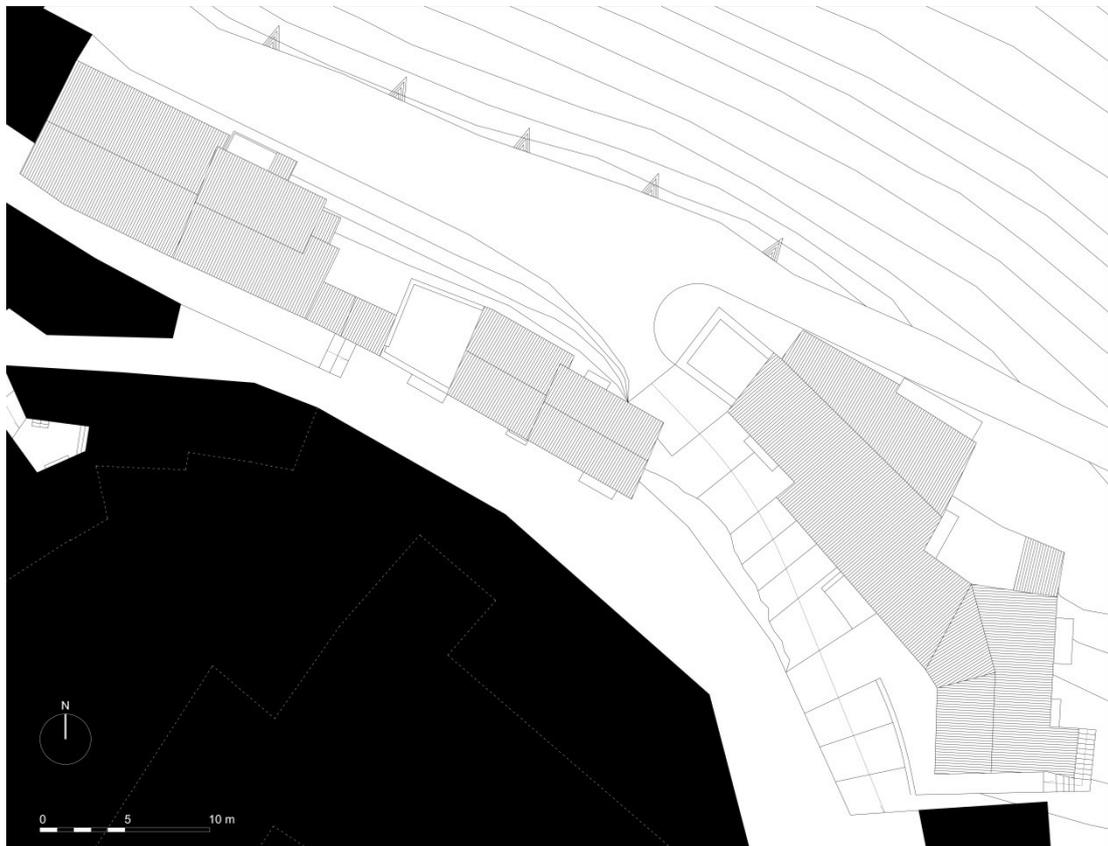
Comparto n°4 / Planimetria delle coperture
